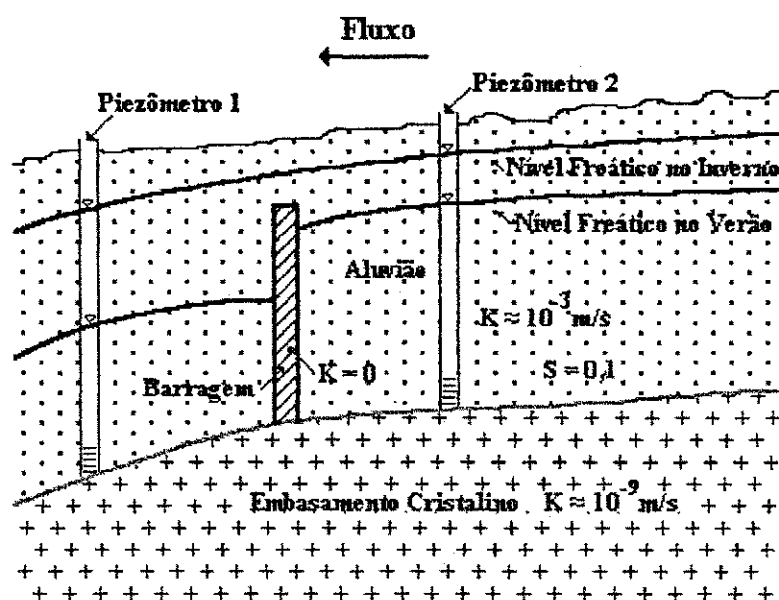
Desenho esquemático da barragem submersa no aluvião
